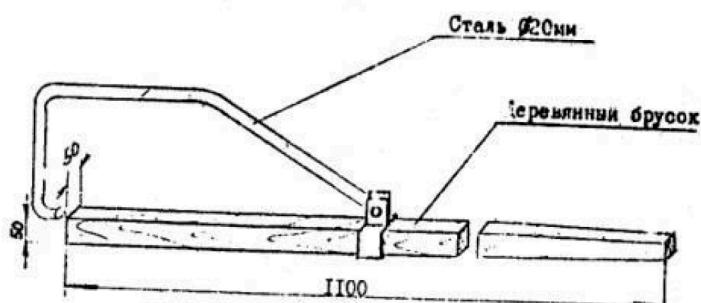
Приспособление для кантования железобетонных опор при их установке
